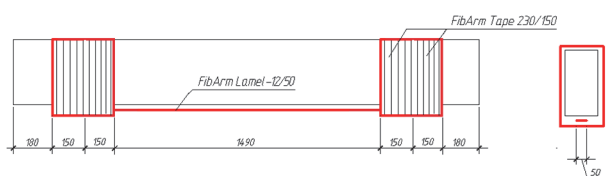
Схема оклейки железобетонных моделей углеродными ламелями
